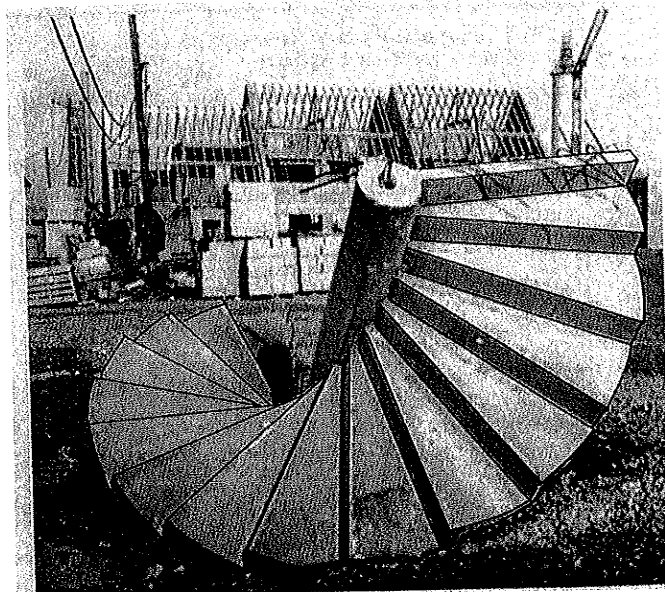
Escalier balancé préfabriqué de pavillon.
